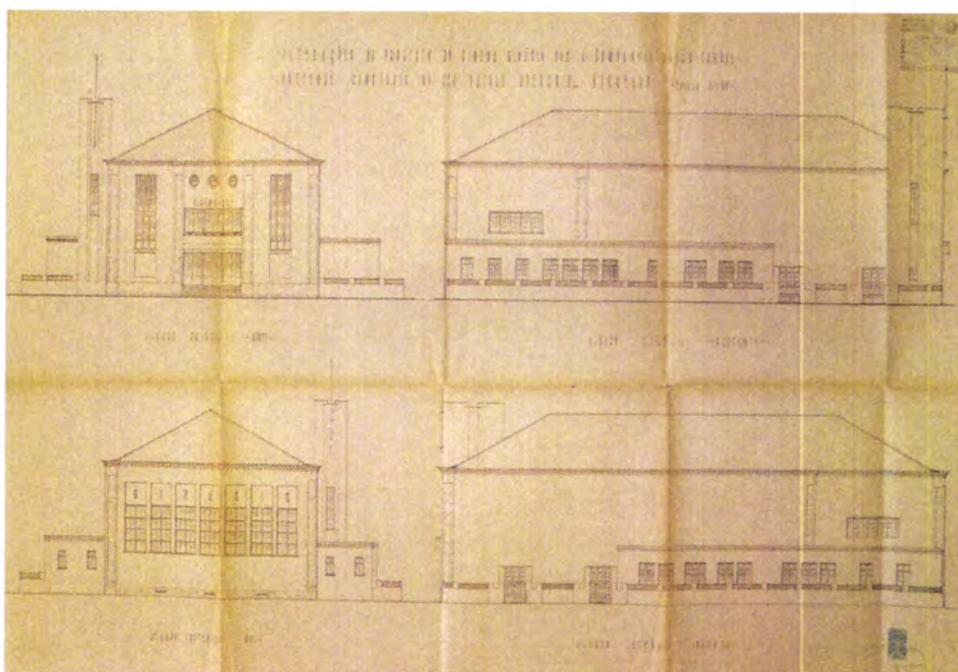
Planta das fachadas exteriores do Cinema – Ginásio. Arquivo Municipal – C. M. Barreiro.
